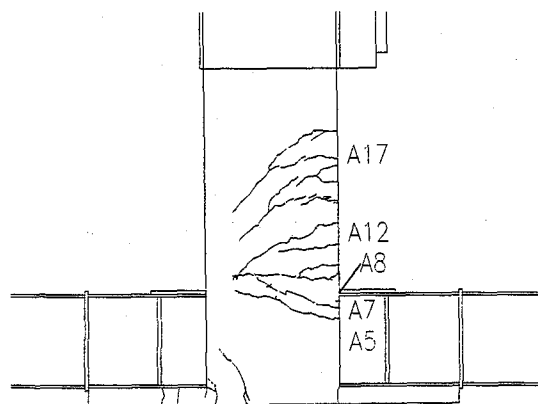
TYPE 1-3 1.0 δ_y 載荷時橋脚ひび割れ図
